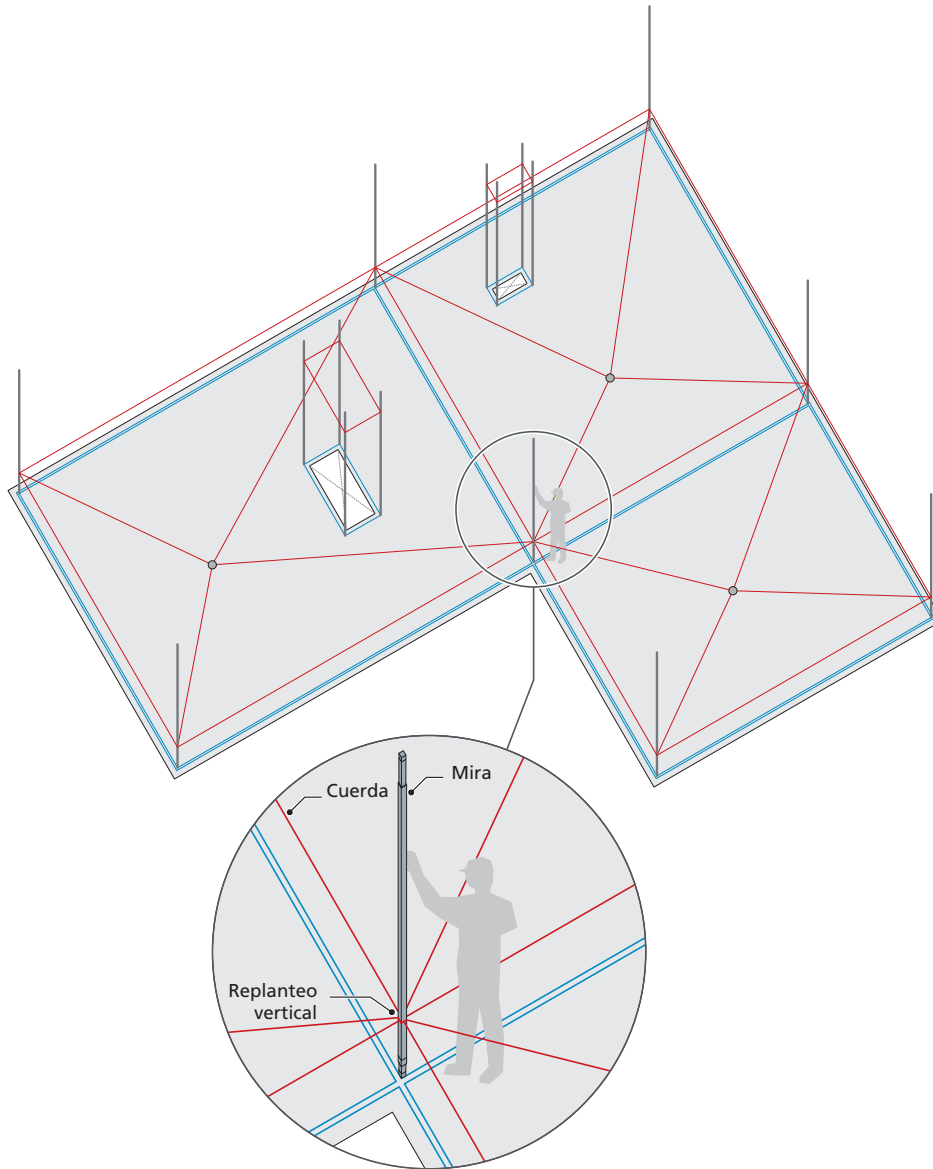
Replanteo de tabiques palomeros perpendiculares al alero en cubierta plana sobre forjado
